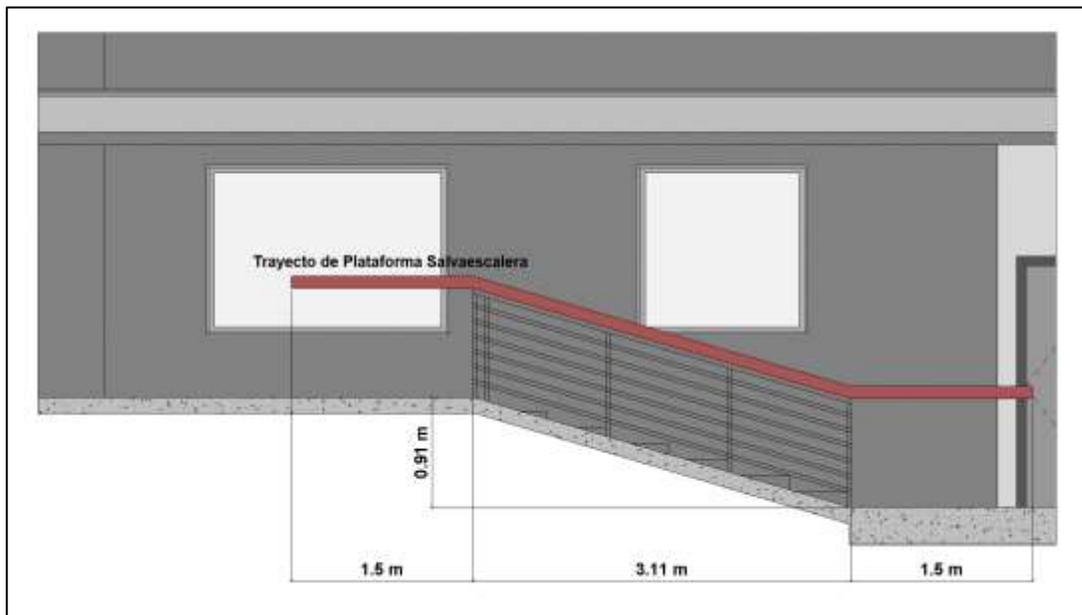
Corte Longitudinal Rampa Acceso Morandé
